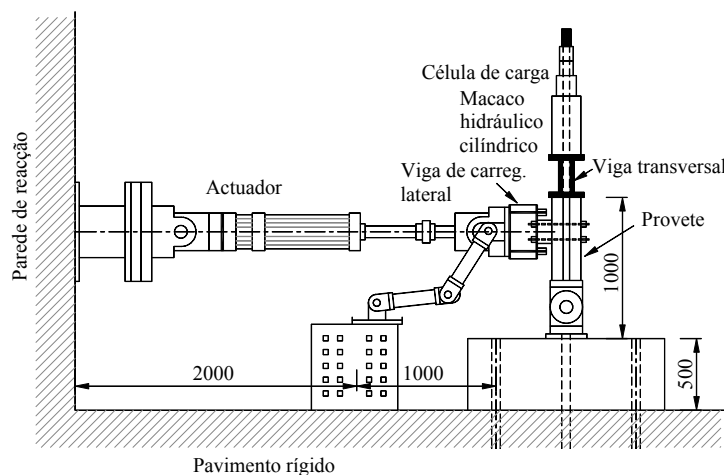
Setup de ensaio usado por Chun e Park.
